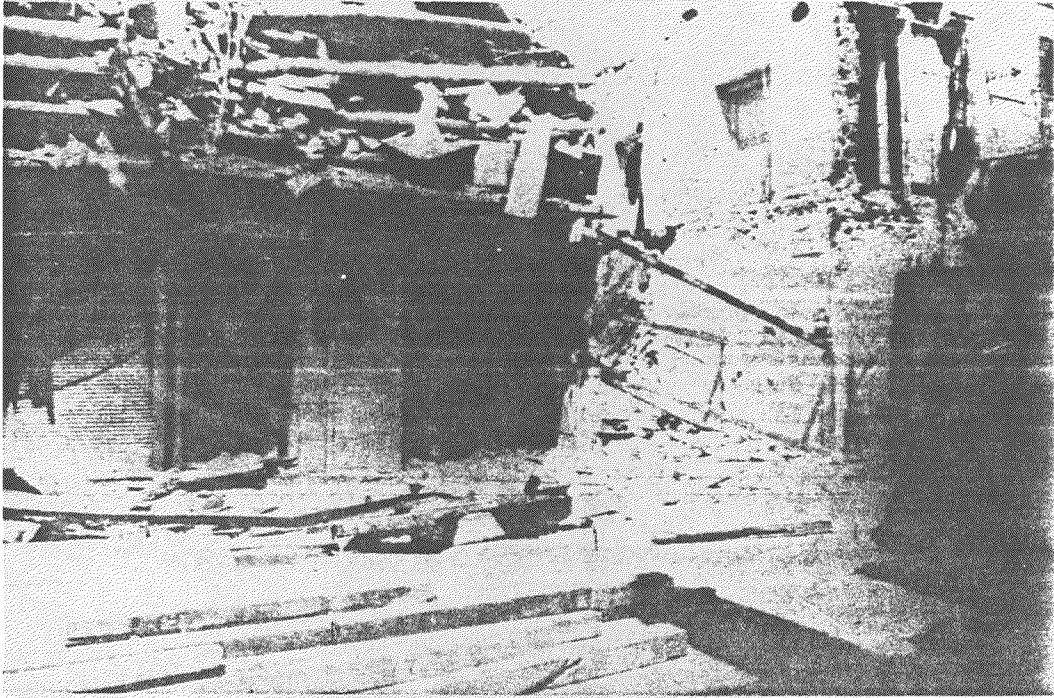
Colapso total de una edificación de 8 pisos ocurrido en Ciudad de México en el año 1985, por fallas en el sistema de tipo túnel o de cajones de concreto armado, sostenido precariamente por una reja Santa María que cumplió las funciones de pantalla transversal. (foto Salvatierra)
